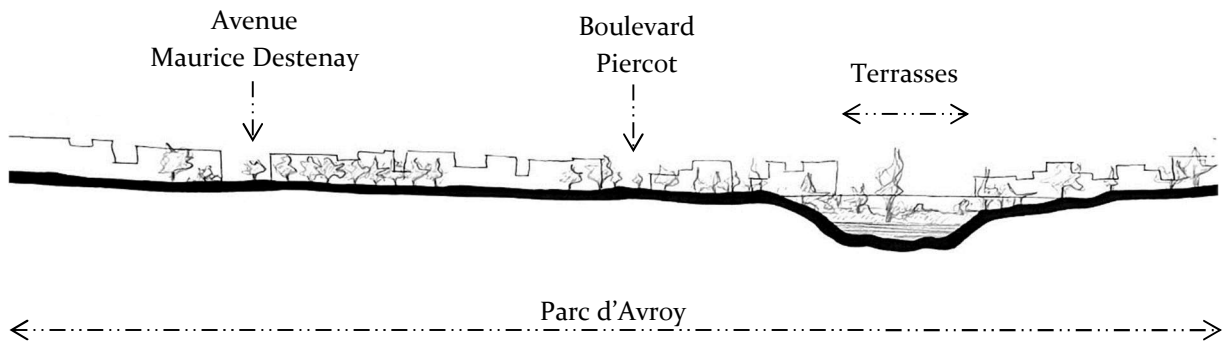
Coupe longitudinale – centre du Parc d'Avroy
